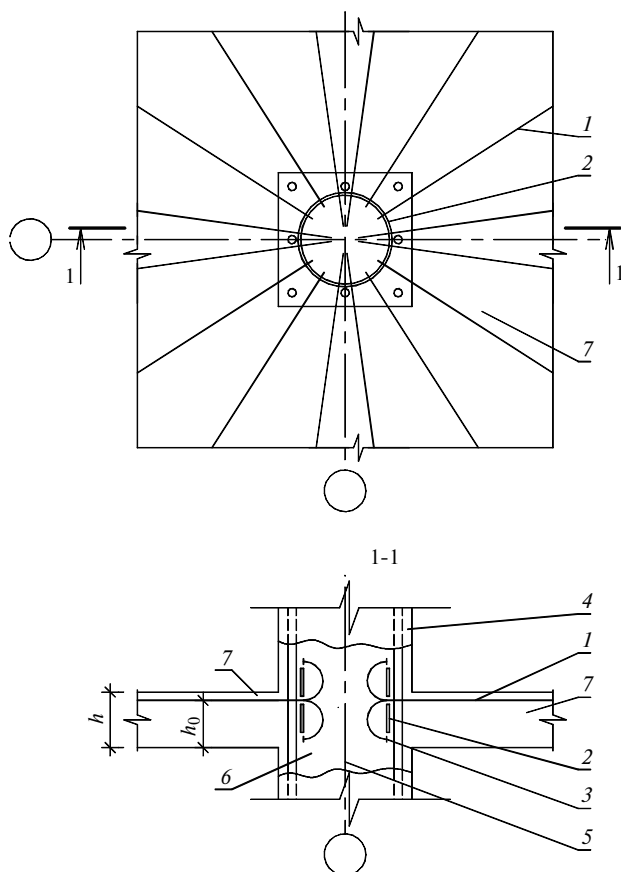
Стык арматуры плоской плиты перекрытия посредством анкерных колец:
